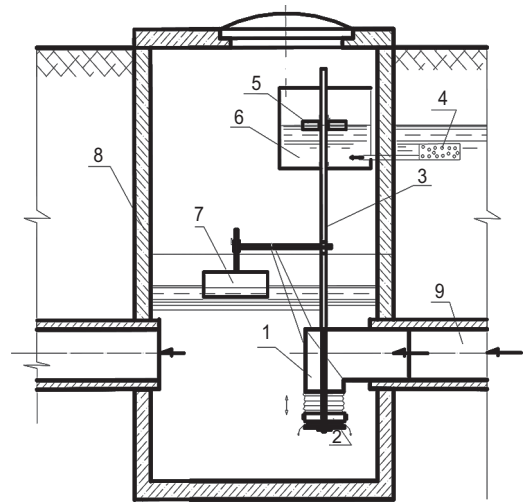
Схема гідрорегулятора РГВ двосторонньої дії: 1 — корпус регулятора; 2 — запірний клапан; 3 — штанга; 4 — фільтр; 5, 7 — датчики рівня; 6 — поплавок камери; 8 — колодязь; 9 — дренажний колектор
